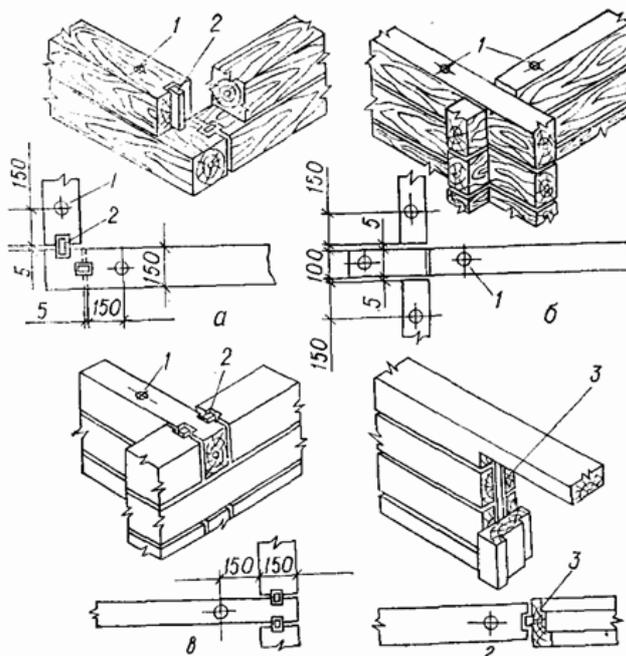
Сопряжения элементов при сборке конструкций из брусьев: а — сопряжение брусьев наружных стен; б — то же, внутренних; в — то же, наружной стены с внутренней; 2 — сопряжение оконной коробки с брусьями наружной стены; 1 — нагели; 2 — шпонки 32 x 50 x 140 мм; 3 — рейка 32 x 30 мм по высоте коробки
